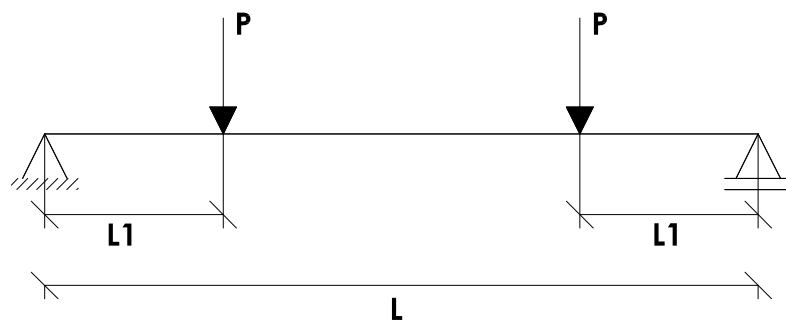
Sistema estrutural adotado nos ensaios de flexão.
